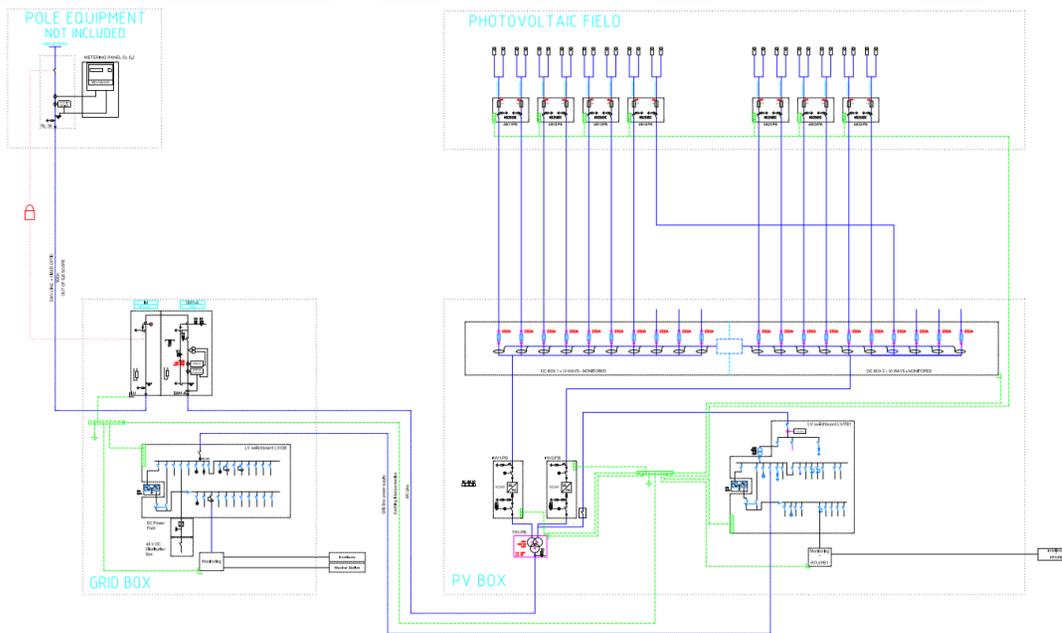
Plano unifilar de la Planta Solar Andacollo
